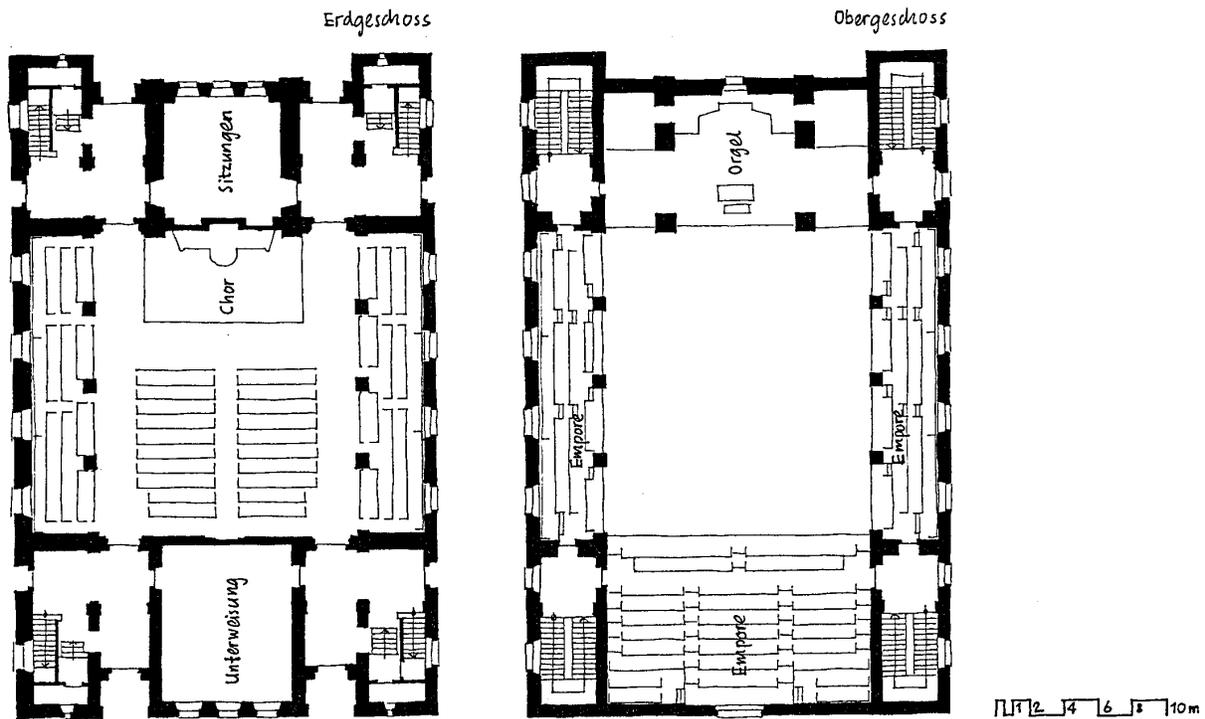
Grundriss evangelische Kirche Arbon
